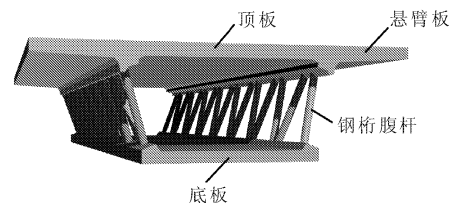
钢桁腹式混凝土组合箱梁的构造示意图
